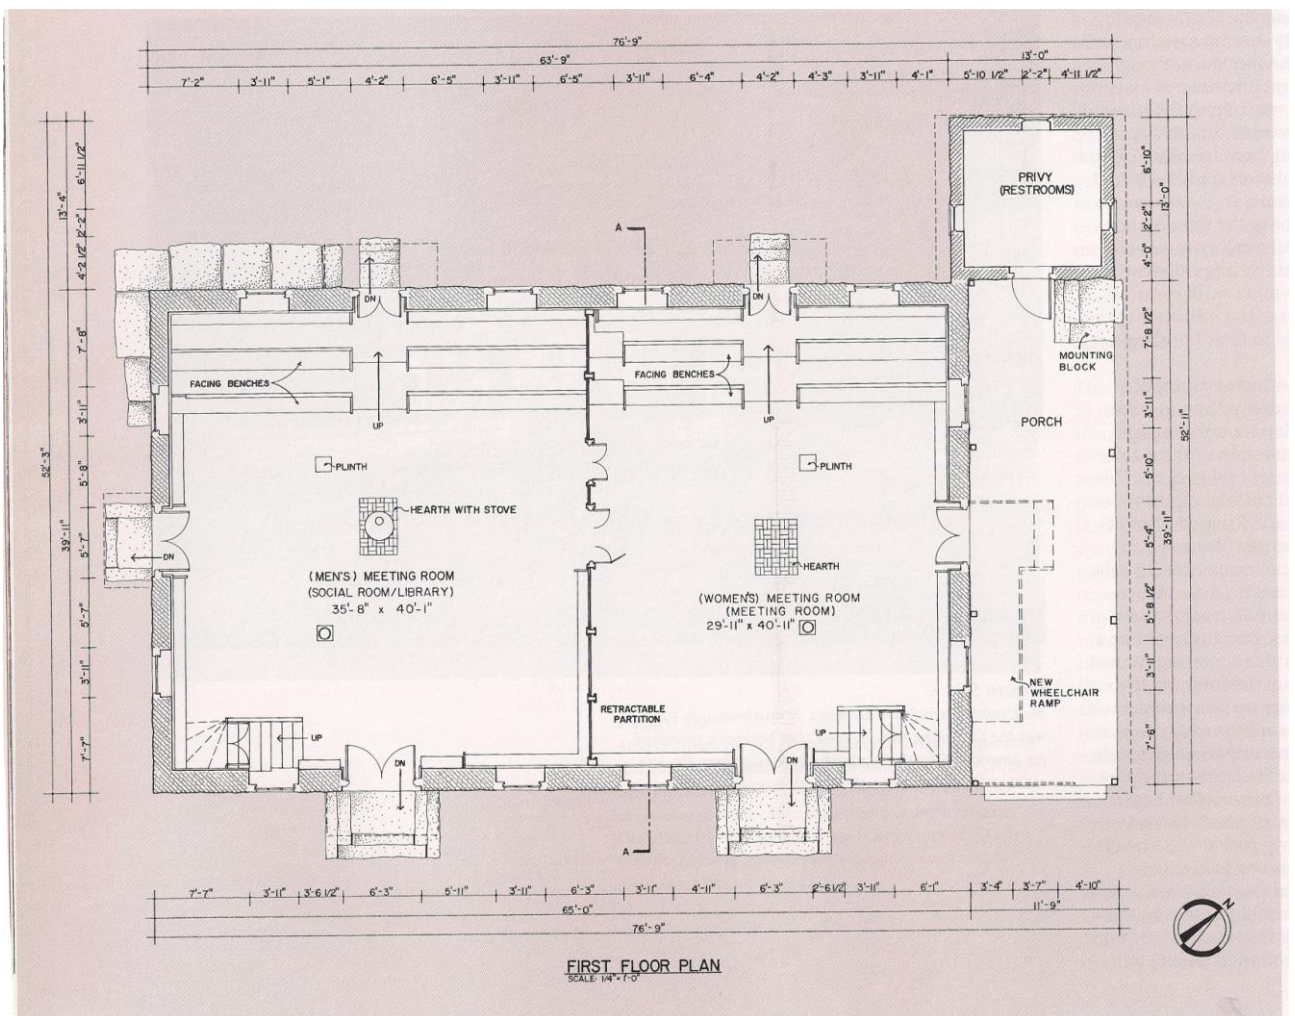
Prancha de levantamento produzido pelo HABS – Levantamento da Buckingham Meetinghouse
